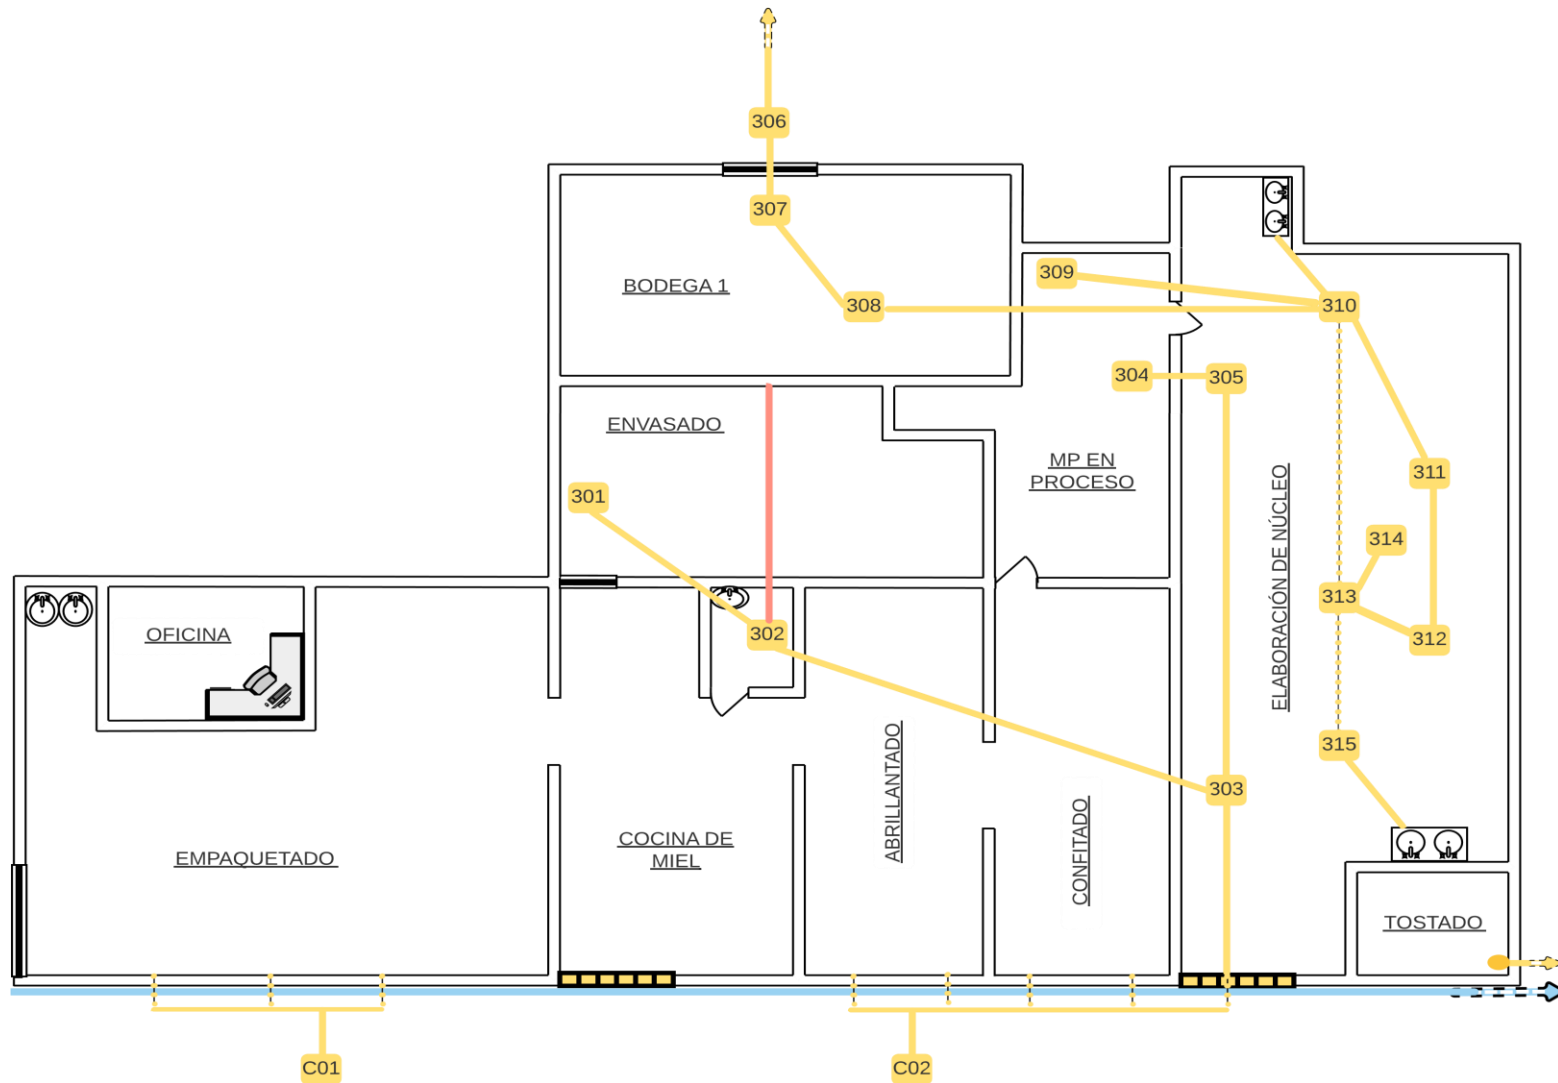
Ilustración de distribución de la Red de Alcantarillado de la Planta Confitería.
